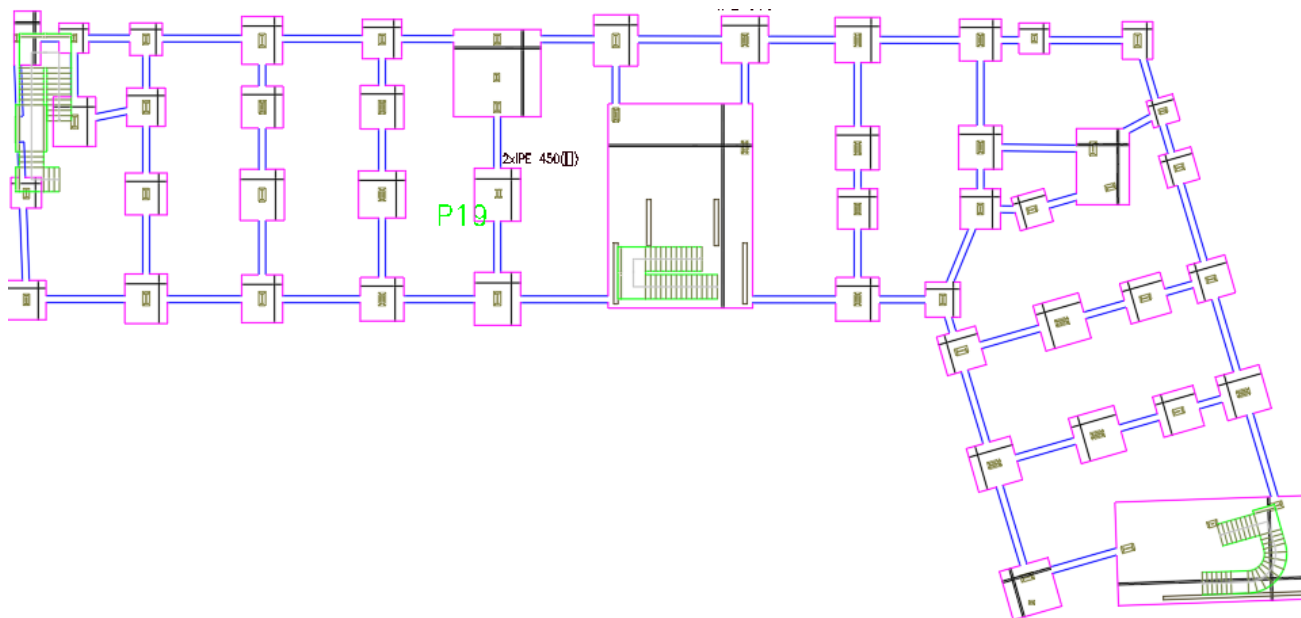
Planta de cimentación donde aparece reflejado el pilar P19
